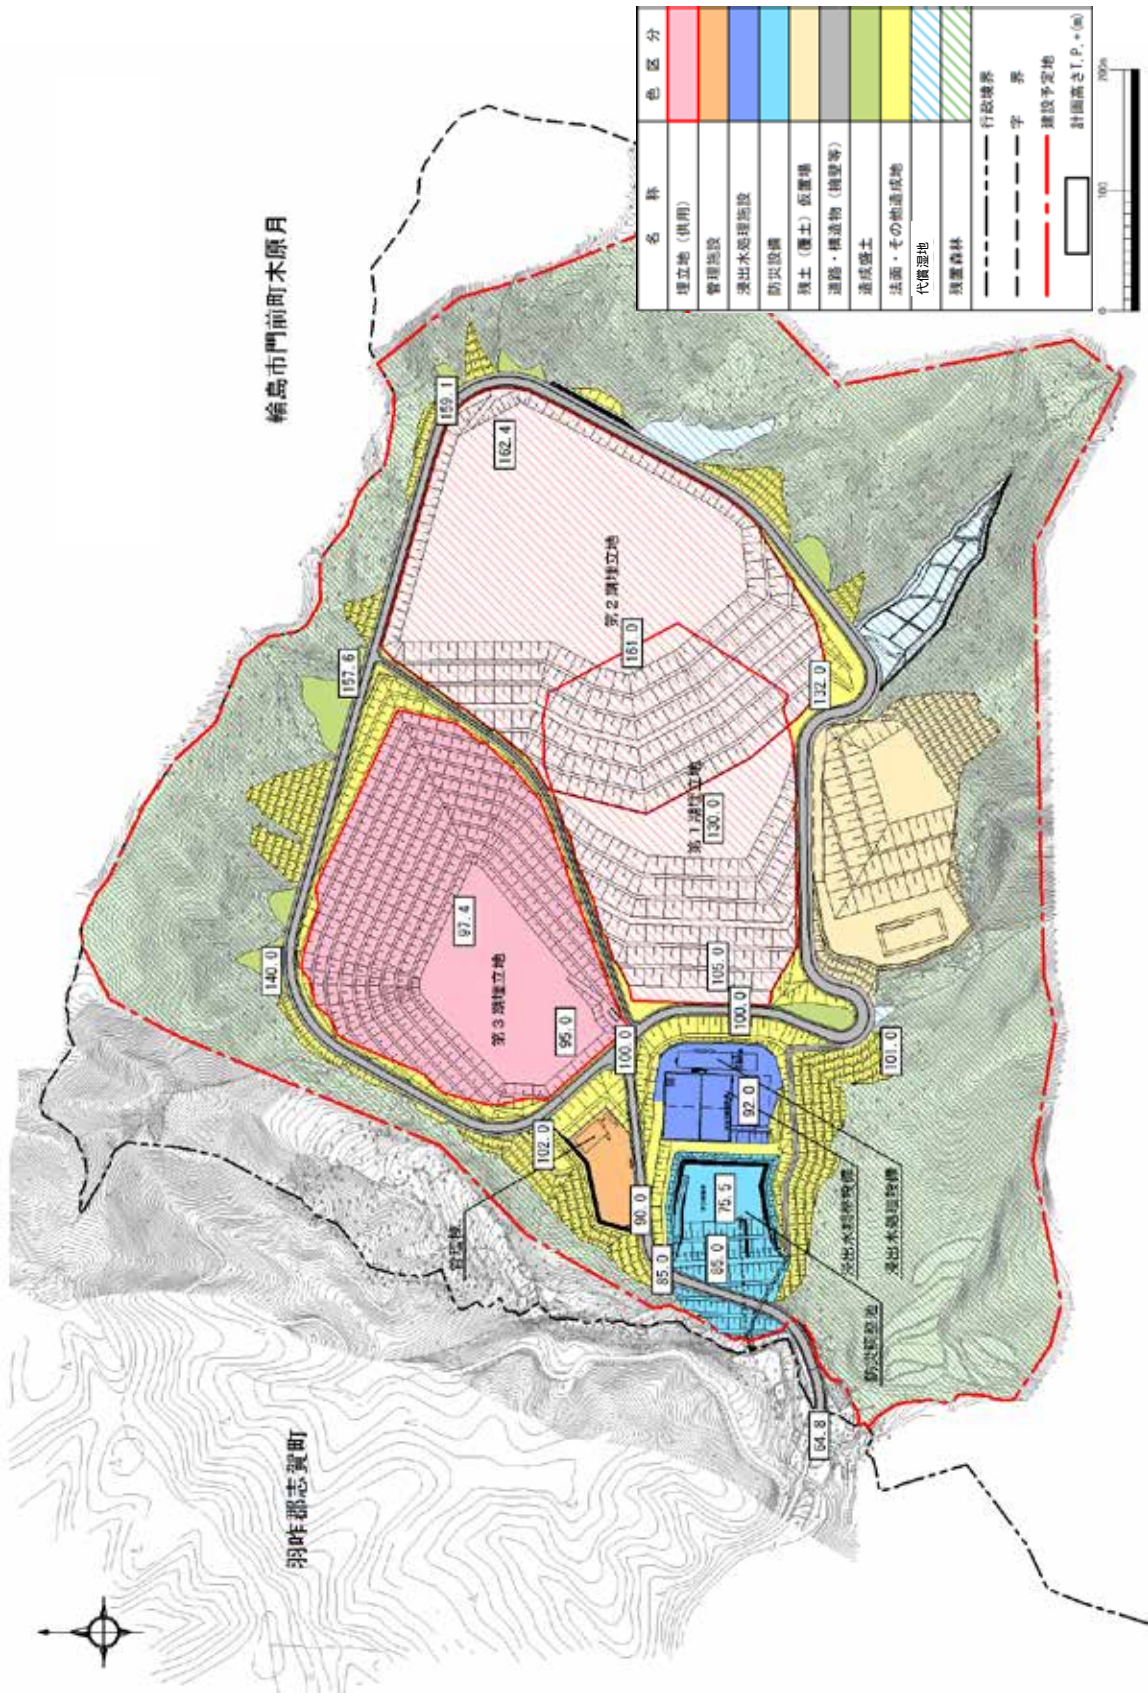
造成・施設配置計画平面図（第 3 期工事完了後）
